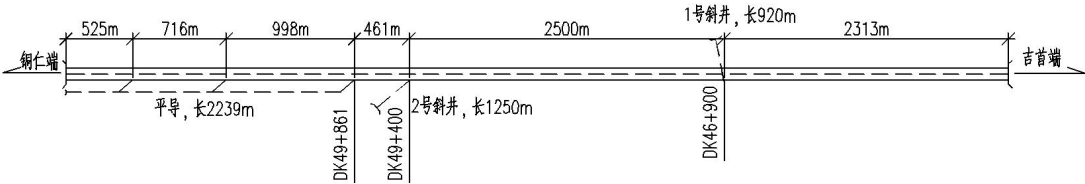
川硐隧道辅助坑道平面布置示意图
